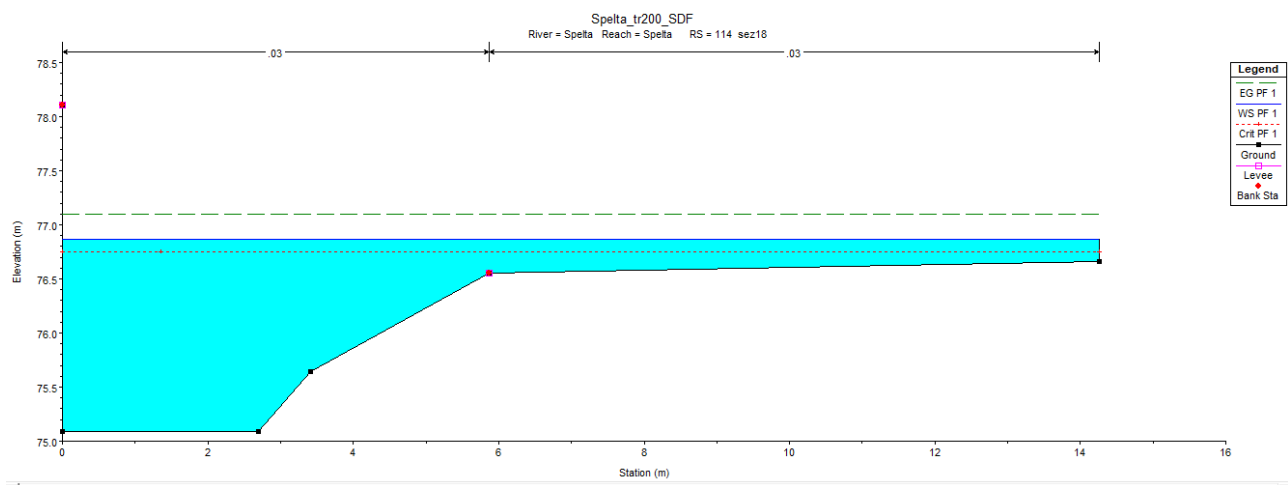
SEZIONE TRASVERSALE 18, A MONTE DEL TRATTO OGGETTO DI INTERVENTO
